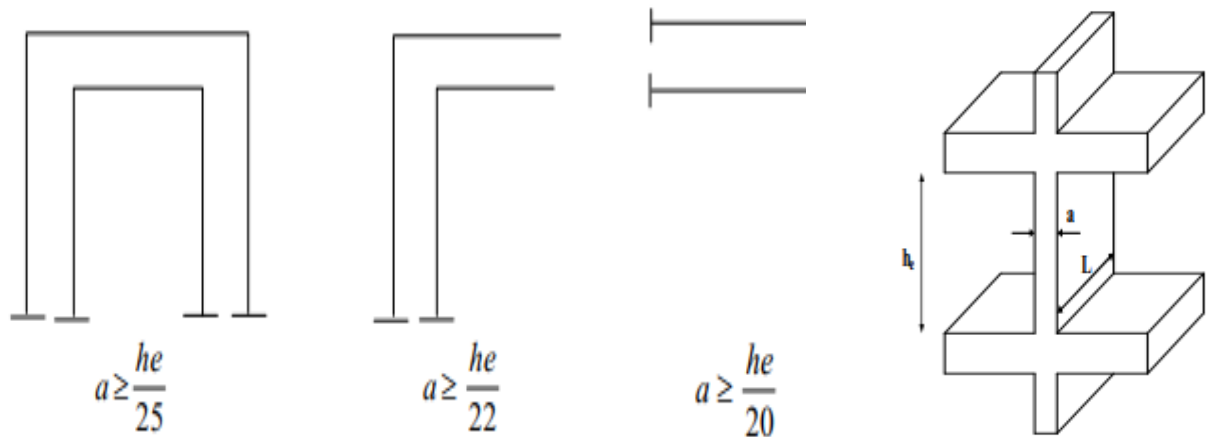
coupe des voiles en plan et coupe de voile en élévation.
